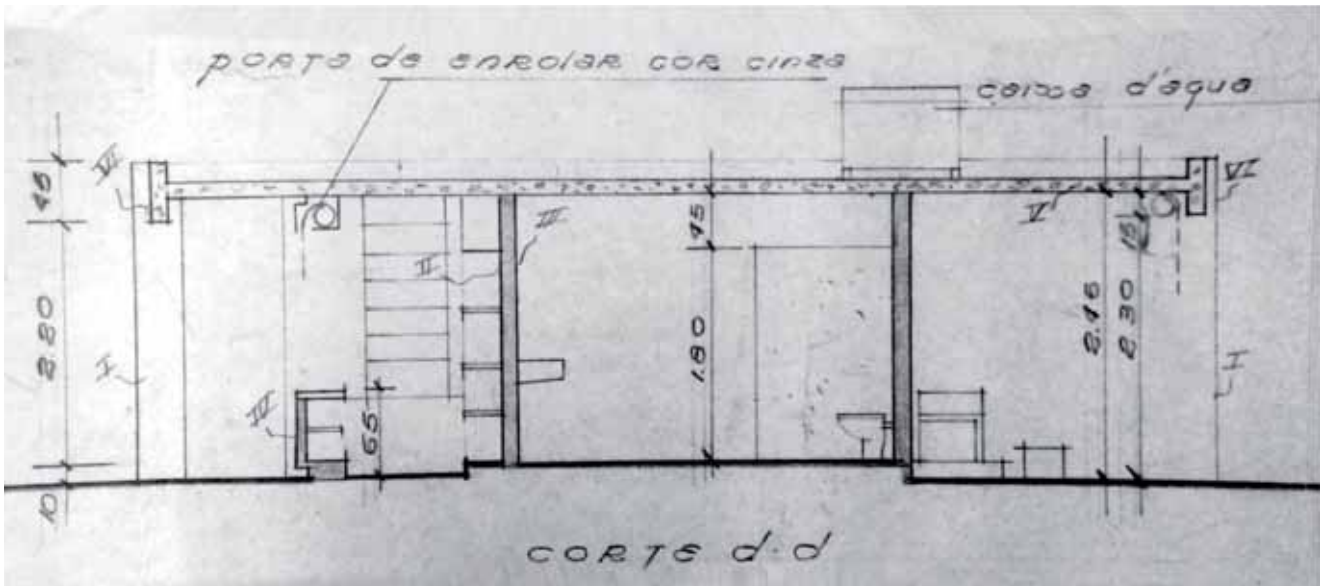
Foto do projeto original de Nauro Esteves – 1964 - corte dd
